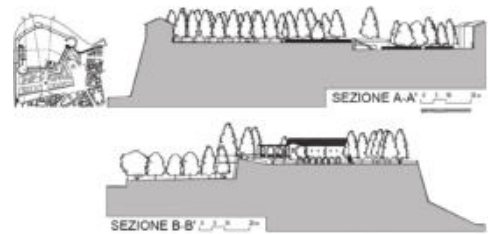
D. Falcioni, M. Mencarelli, Sezioni della Rocca di Camerino nello stato precedente al terremoto del 2016, 2021
